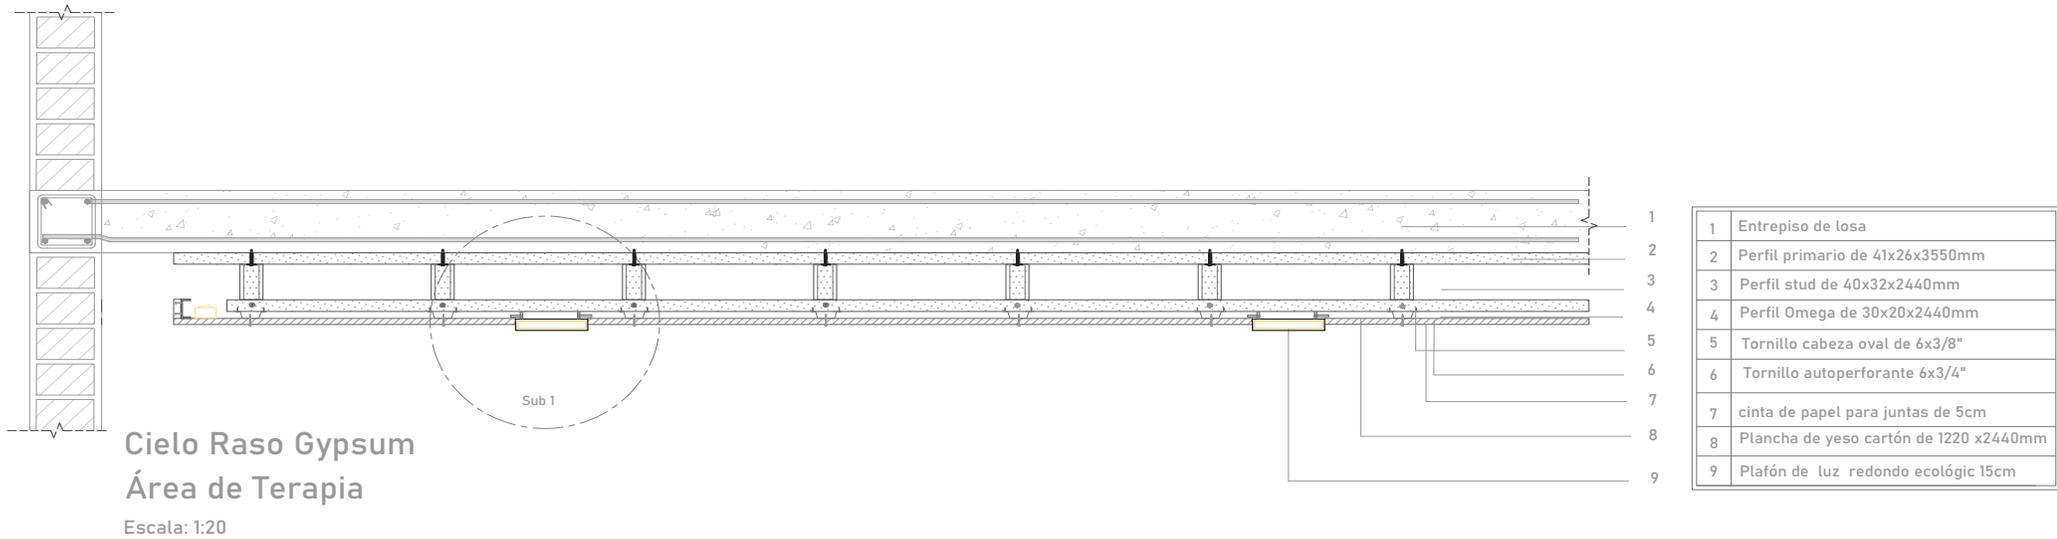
Detalle Cielo raso Gypsum área de terapia
